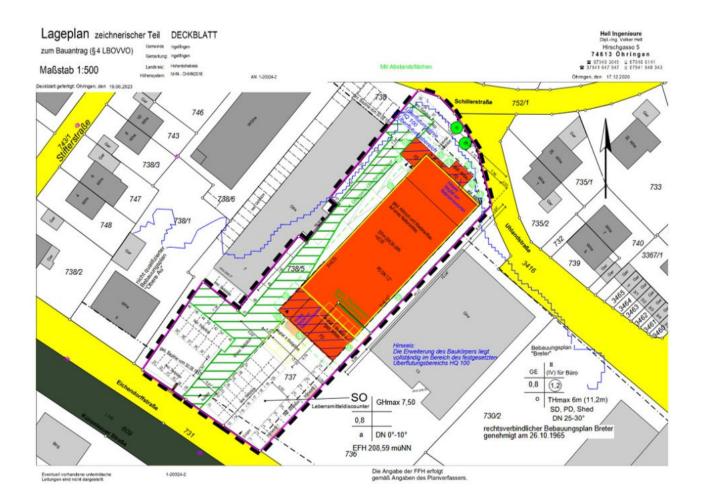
Geplante Ausführung der Erweiterung – Lageplan Stand 19.06.2023
